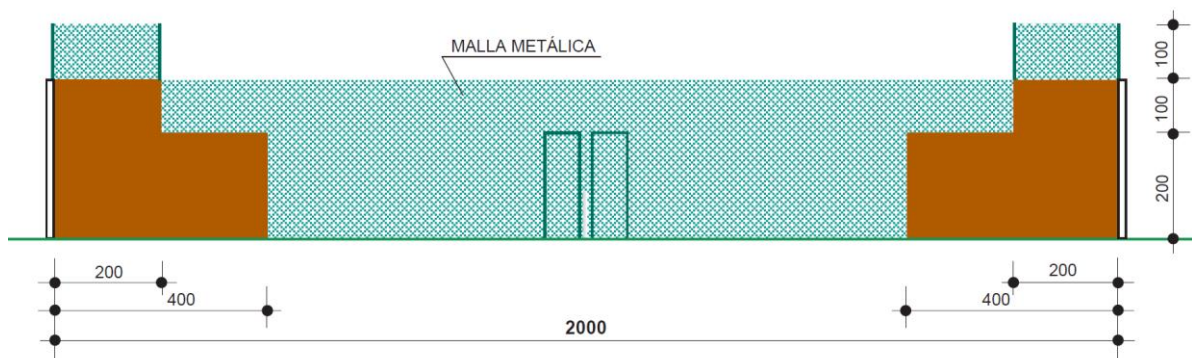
Alzado lateral, pista de pádel (variante 1).
